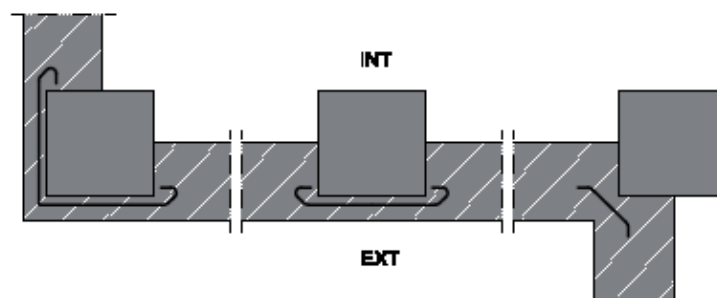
Ejemplo de encuentro de la fachada con los pilares
